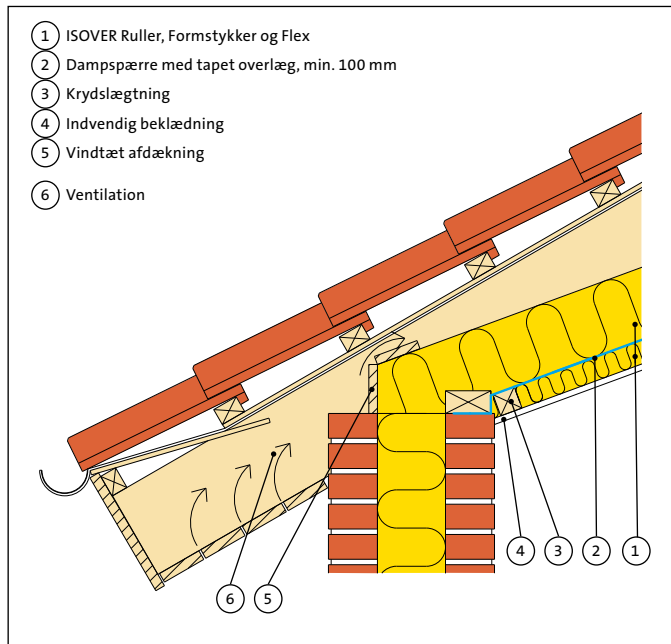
Loft isoleret med ISOVER, hvoraf 45 mm er placeret under dampspærren.
